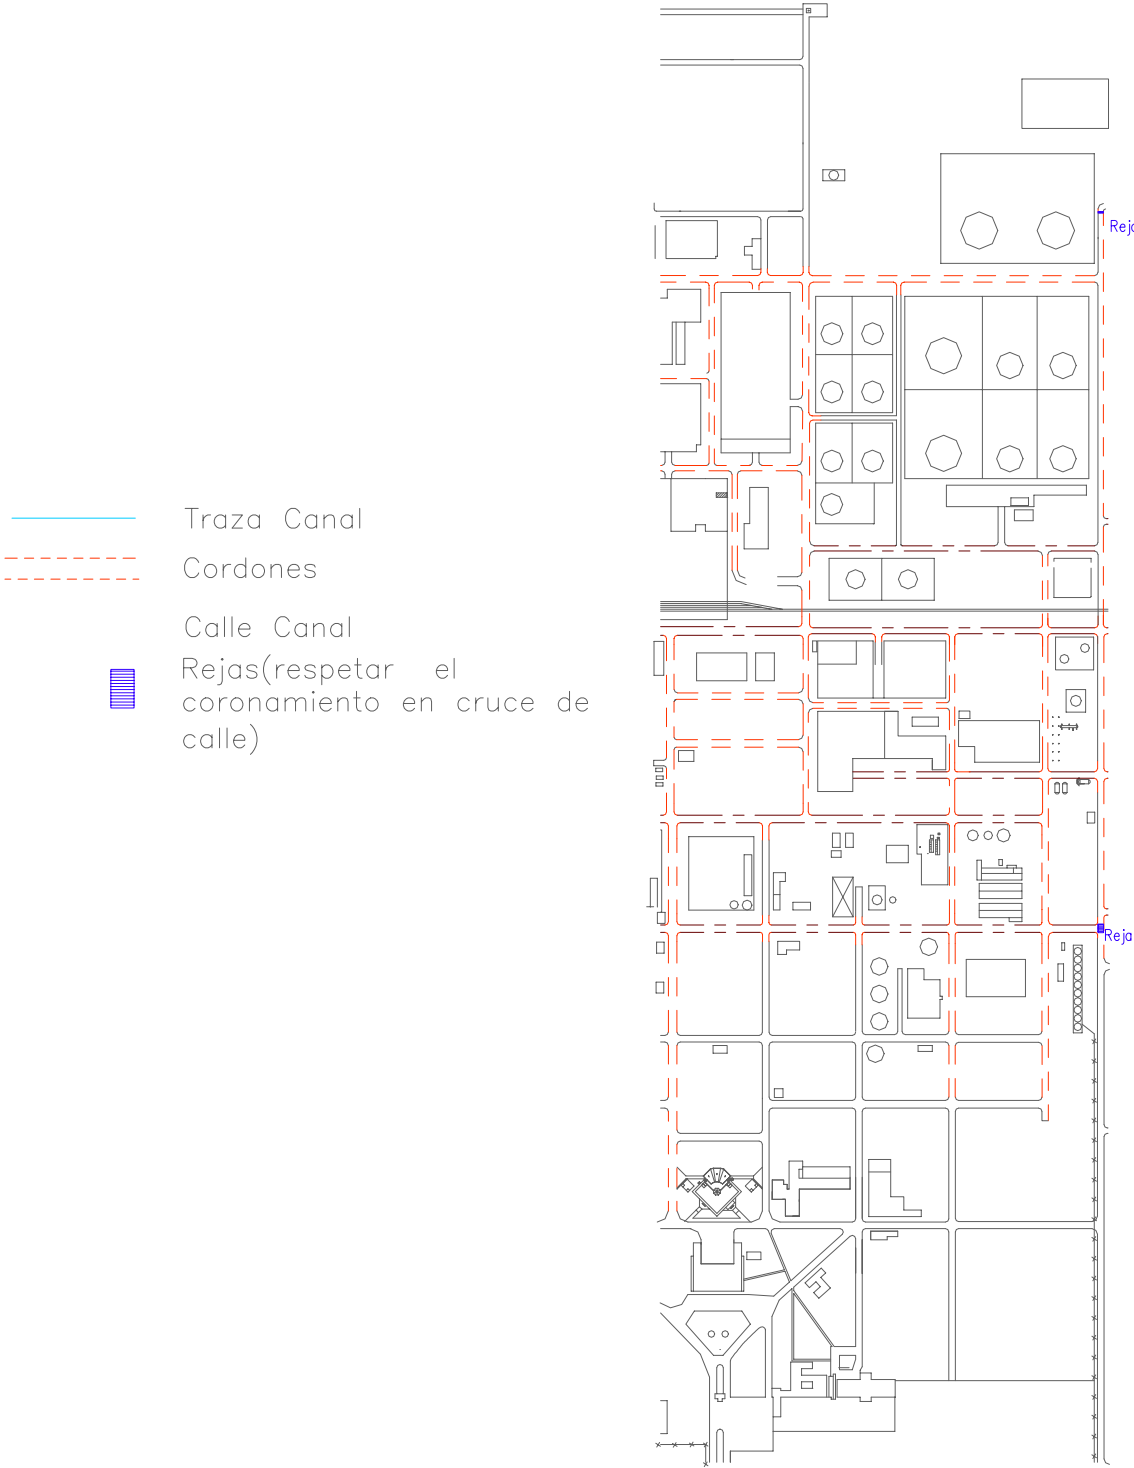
SOLUCIONES ESTRUCTURALES ZONAS ESTE-NORTE Y ESTE-SUR.
